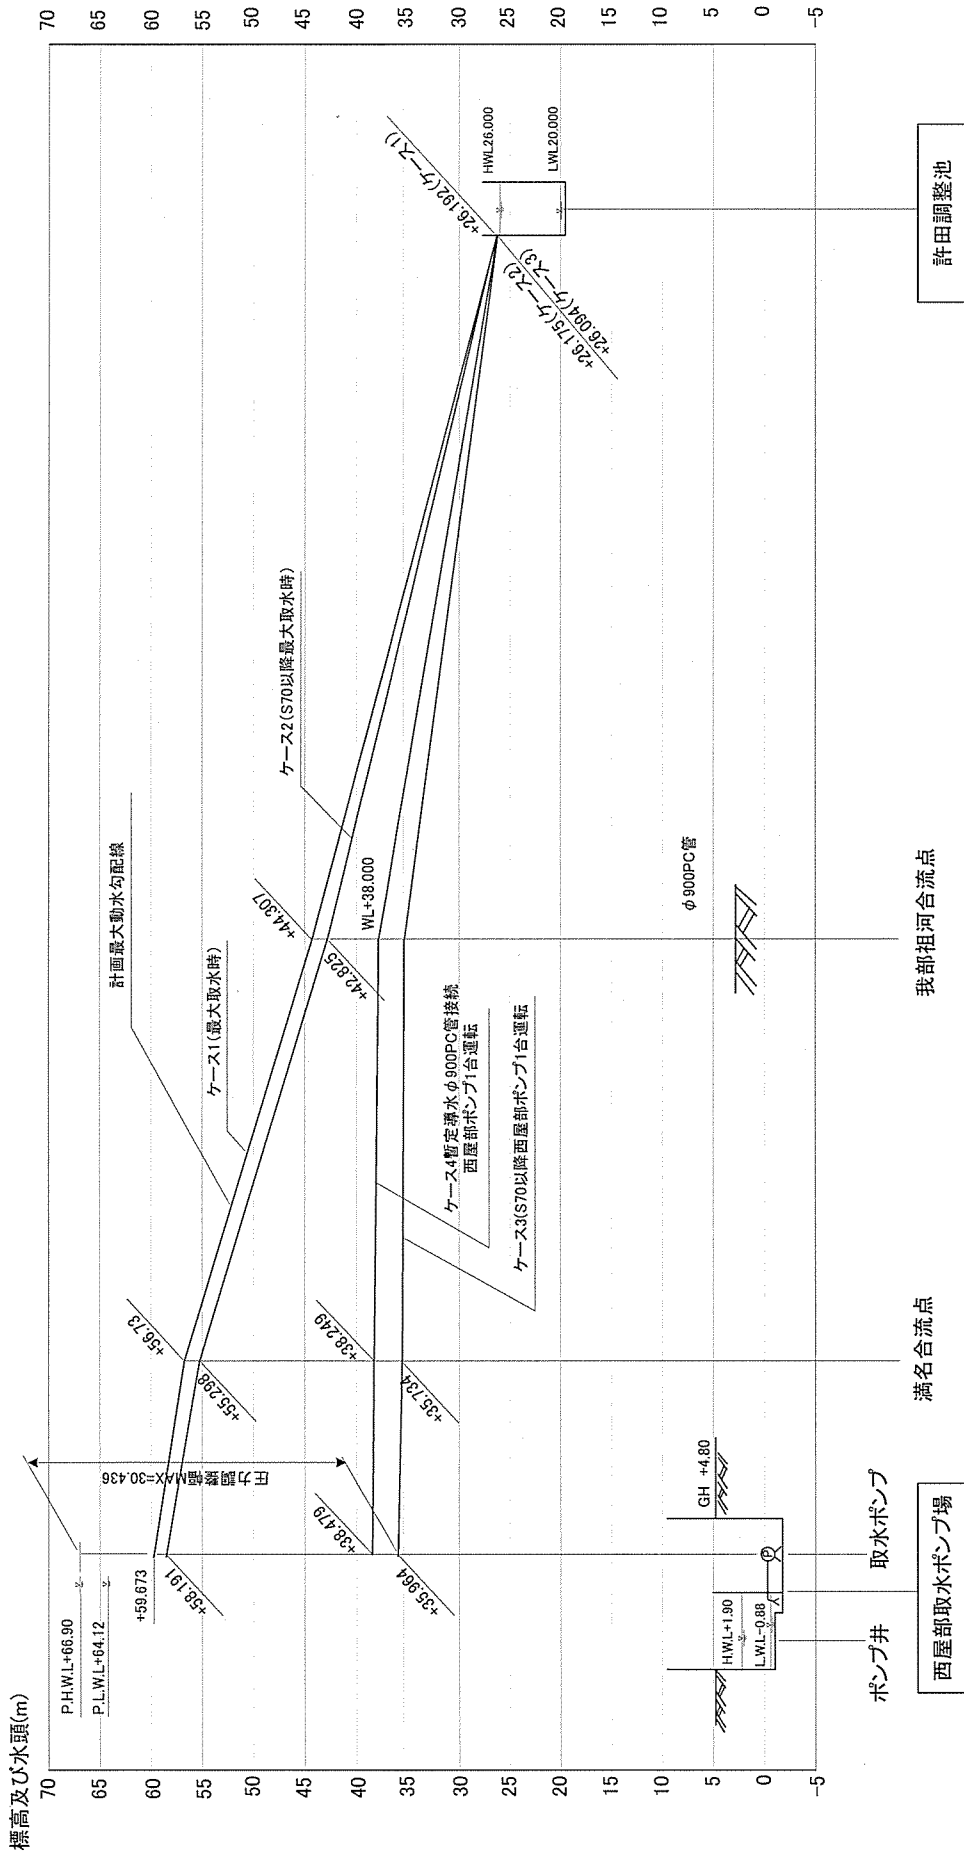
西屋部取水ポンプ場～許田調整池 揚程縦断面図
